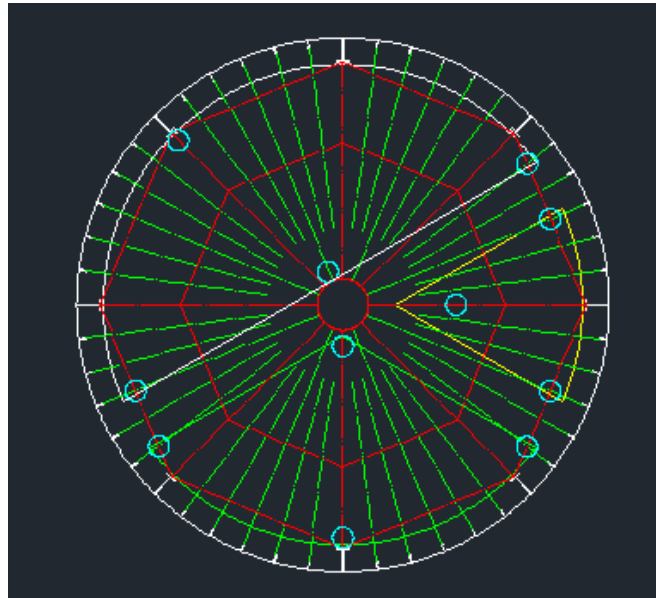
Vista en planta de los silos y los puntales sobre los refuerzos primarios.
